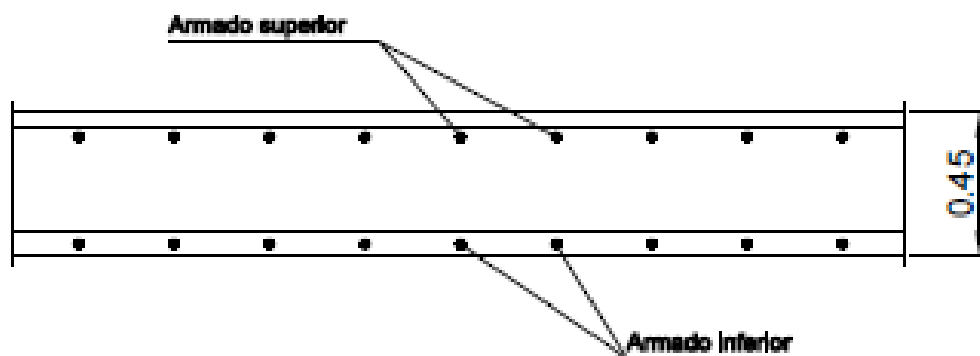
Sección tipo losa. Fuente: CYPE CAD
